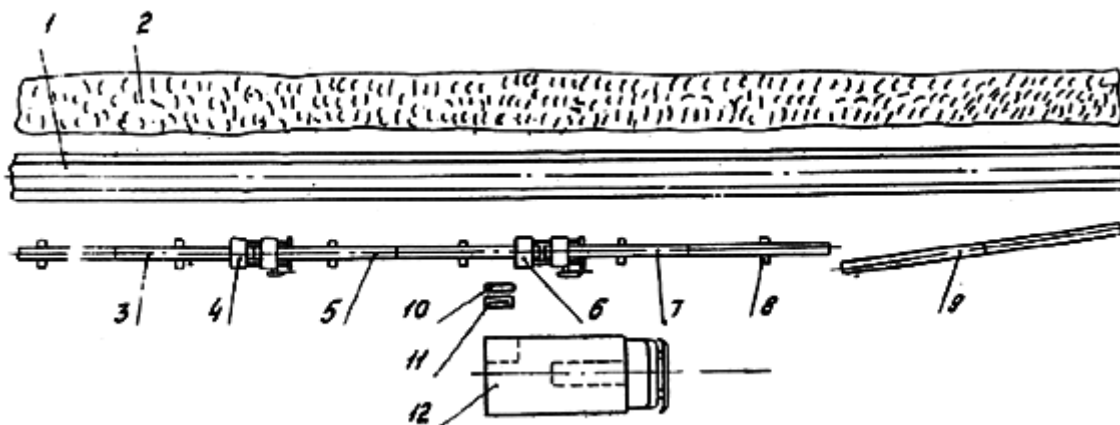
Схема организации сварочного поста при сварке трубопровода в непрерывную нитку с двумя центраторами:
